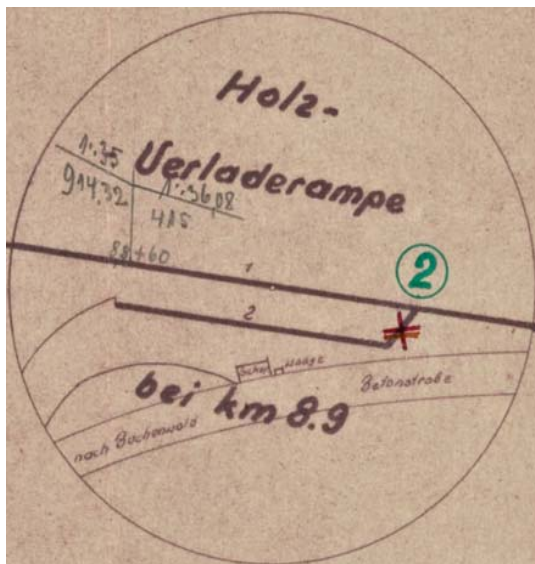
Plan der Holzverladerampe an Km 8,9 1943
